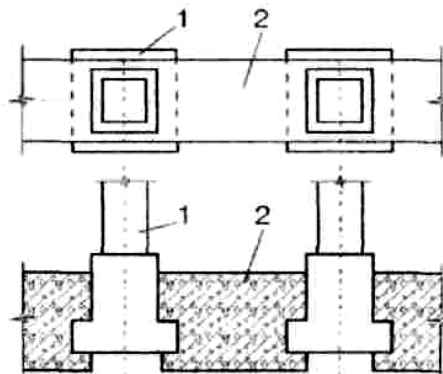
Схема підсилення стовпчастих фундаментів перевлаштуванням їх в стрічкові: 1 – фундамент, що підсилюється; 2 – залізобетонна перемичка
